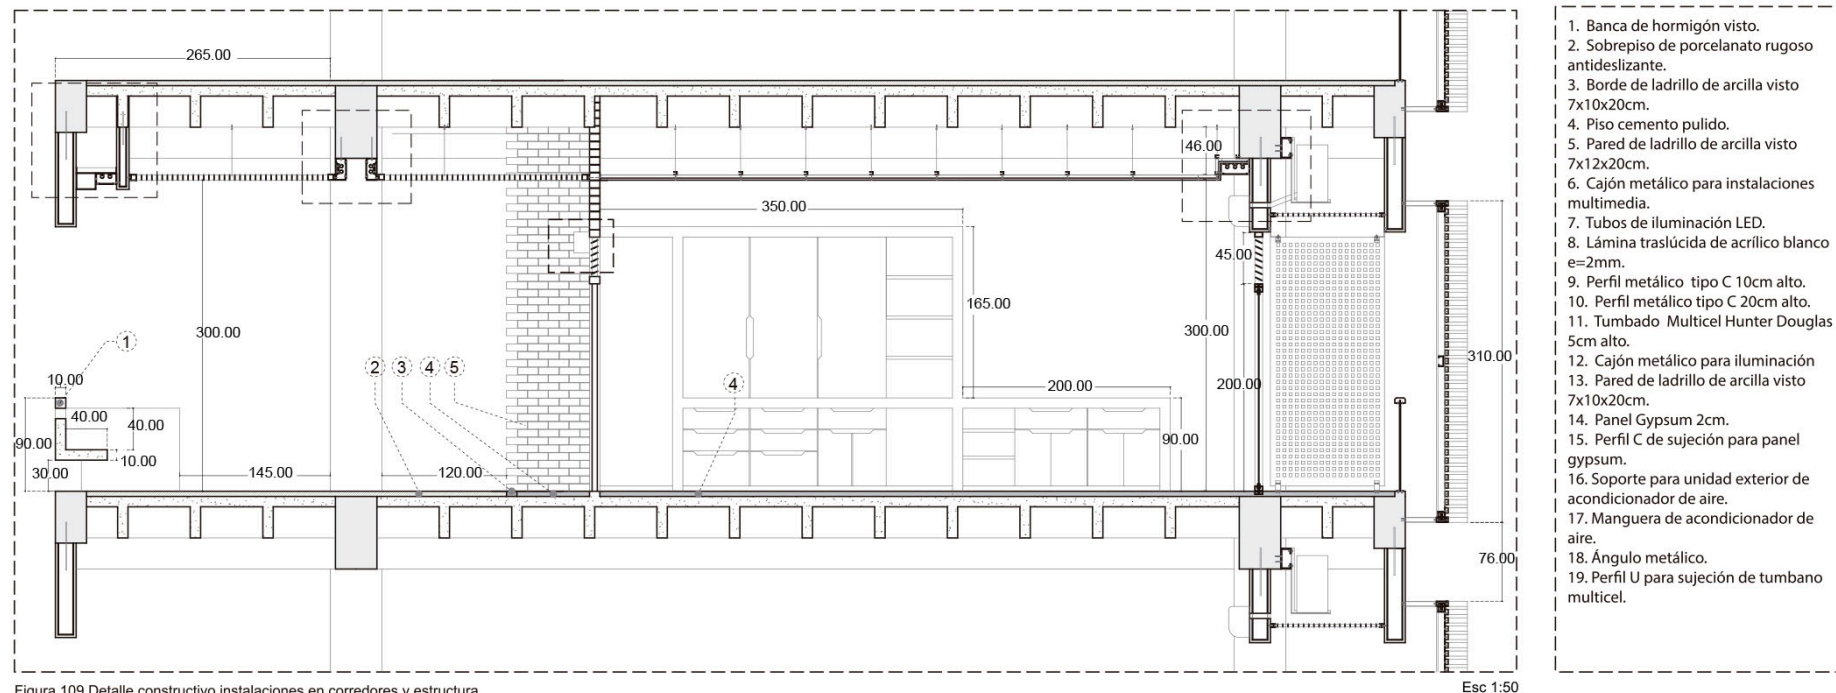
Detalle constructivo instalaciones en corredores y estructura
